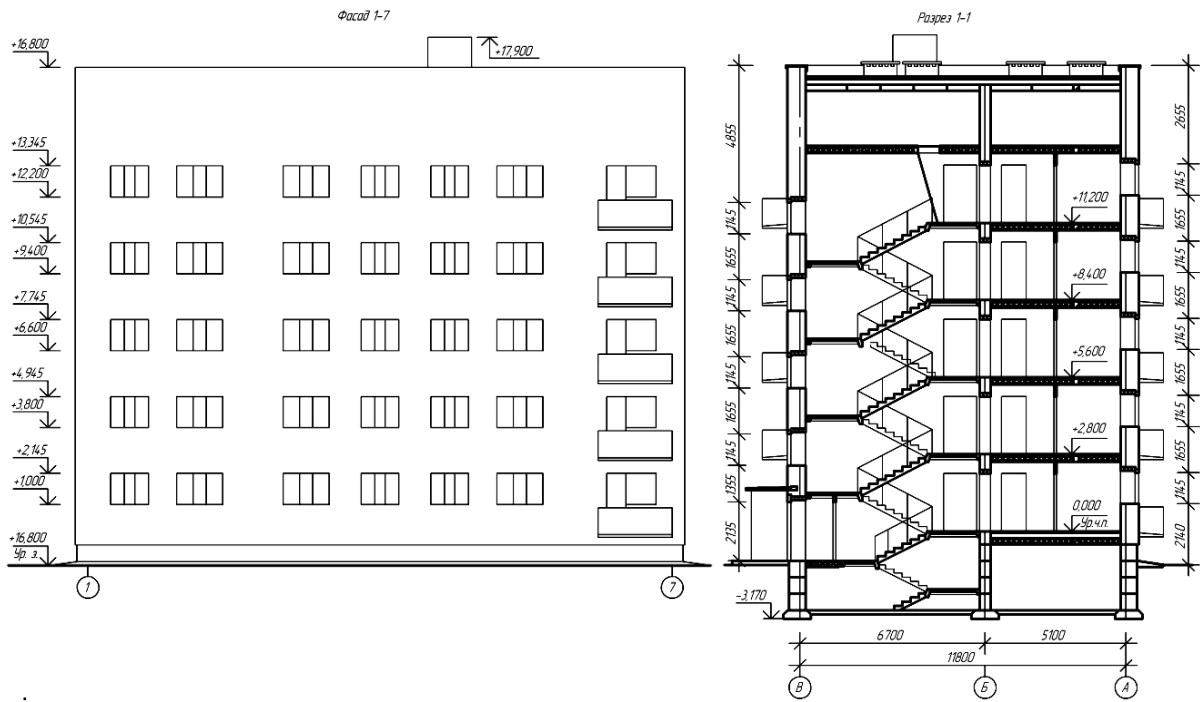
Фасад, разрез и план пятиэтажного девятиквартирного жилого дома. Вариант 4
